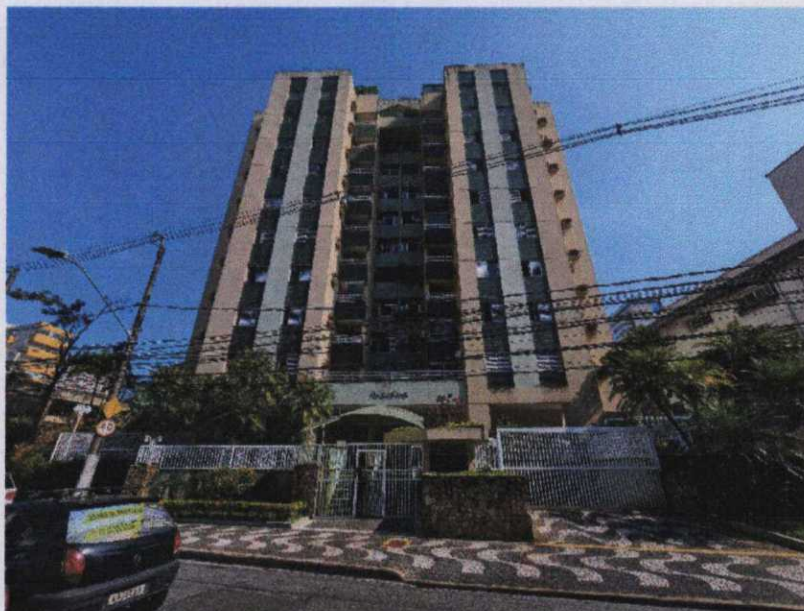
Vista da fachada da edificação de quem da Av. Washington Luis a observa apresentando os seguintes padrões construtivos: fachada parcialmente revestida por cerâmica e parcialmente em pintura látex pva sobre emassamento; muro de divisa revestido com pedra madeira; portões e esquadrias em alumínio; possui cobertura acrílica na entrada de pedestres.
